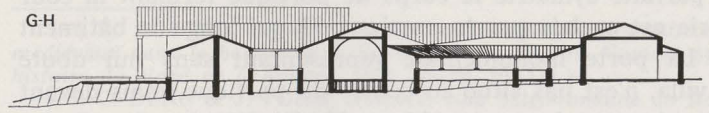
Essai de reconstruction (Ech. 1/800^e).
